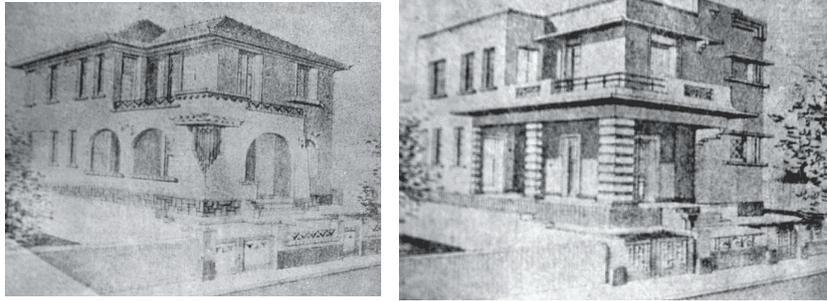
A e B – Modelos de duas fachadas para uma mesma planta. Projeto de Sátiro Brandão. Fonte: Técnica (nº. 8 , 1941).
